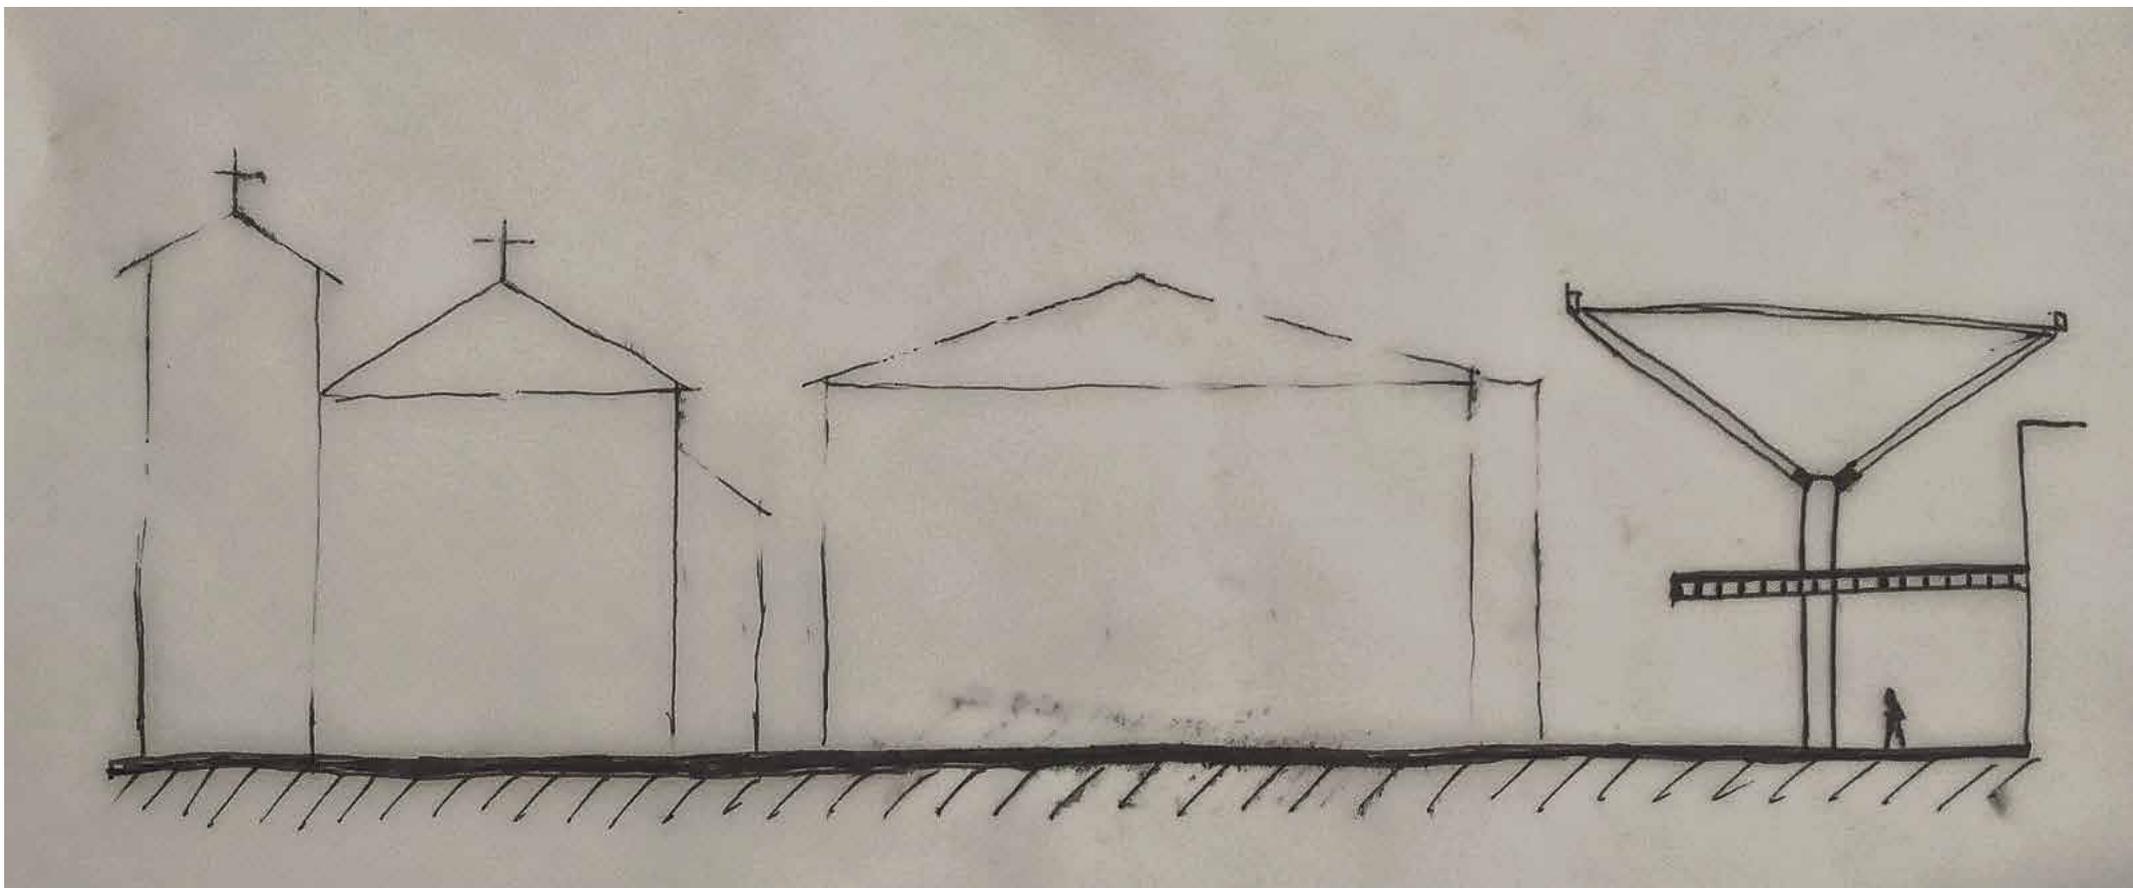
Croqui da paisagem da praça e igreja com a estrutura inserida.
